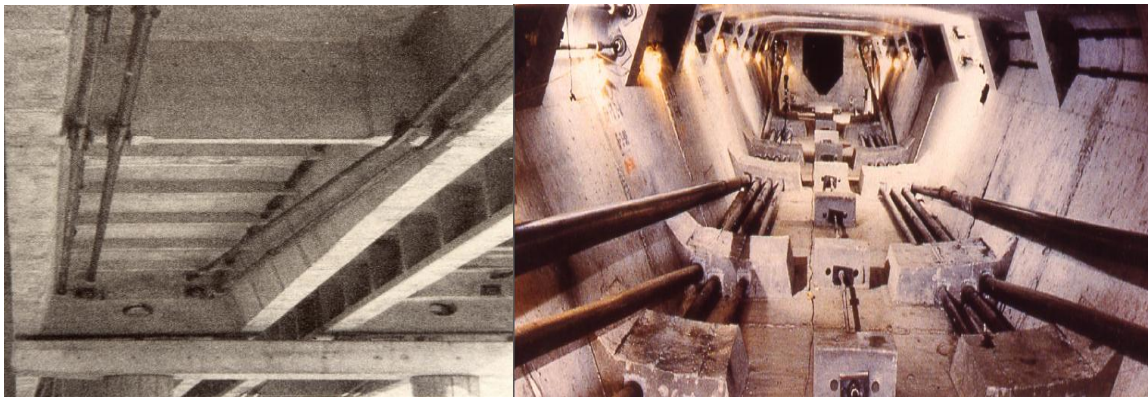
Reparación puente mediante pre-tensado exterior, postesado tablero con traviesas de desviación (Casas Rius, 2012)
